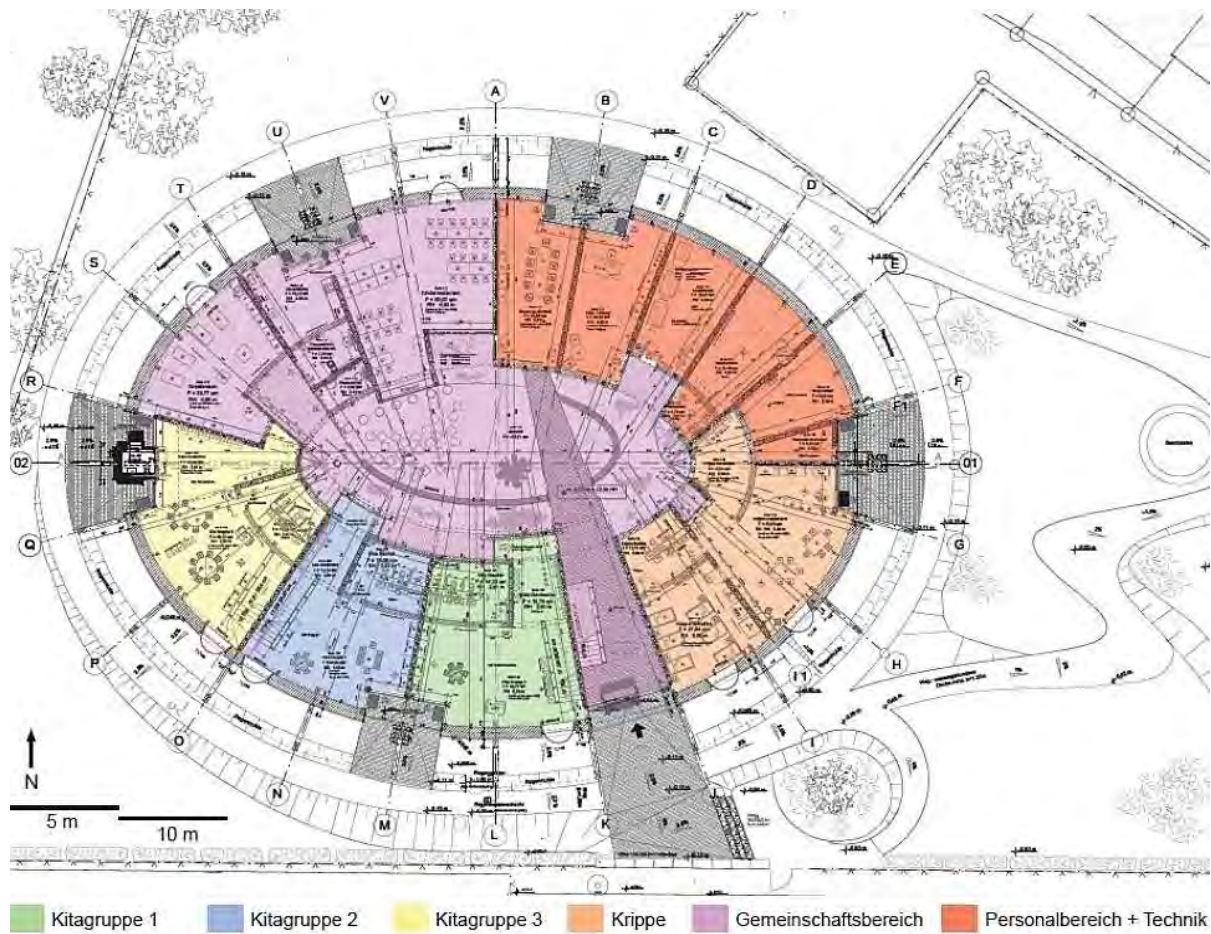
Grundriss Erdgeschoss – Kindertagesstätte „Wildblume“
